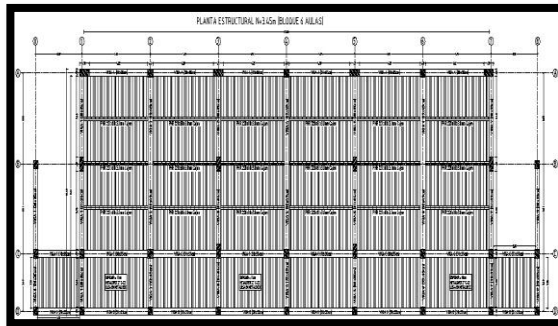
Planta estructural N + 3.45 del Bloque de aulas.
